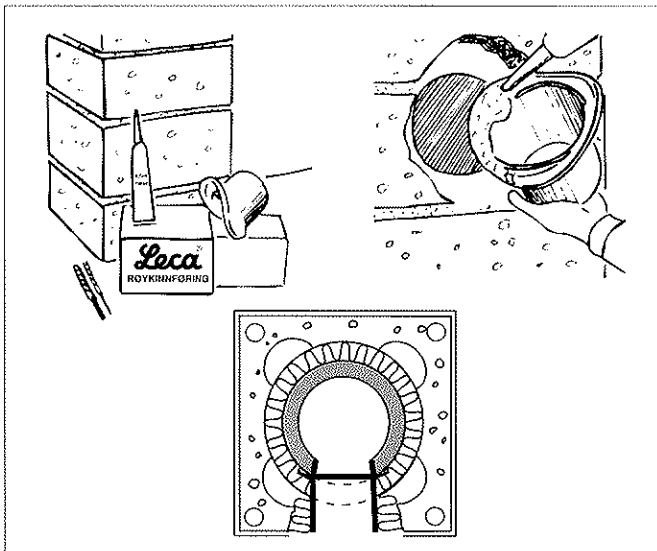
Montering av røykinnføring. Tetting er meget viktig.
